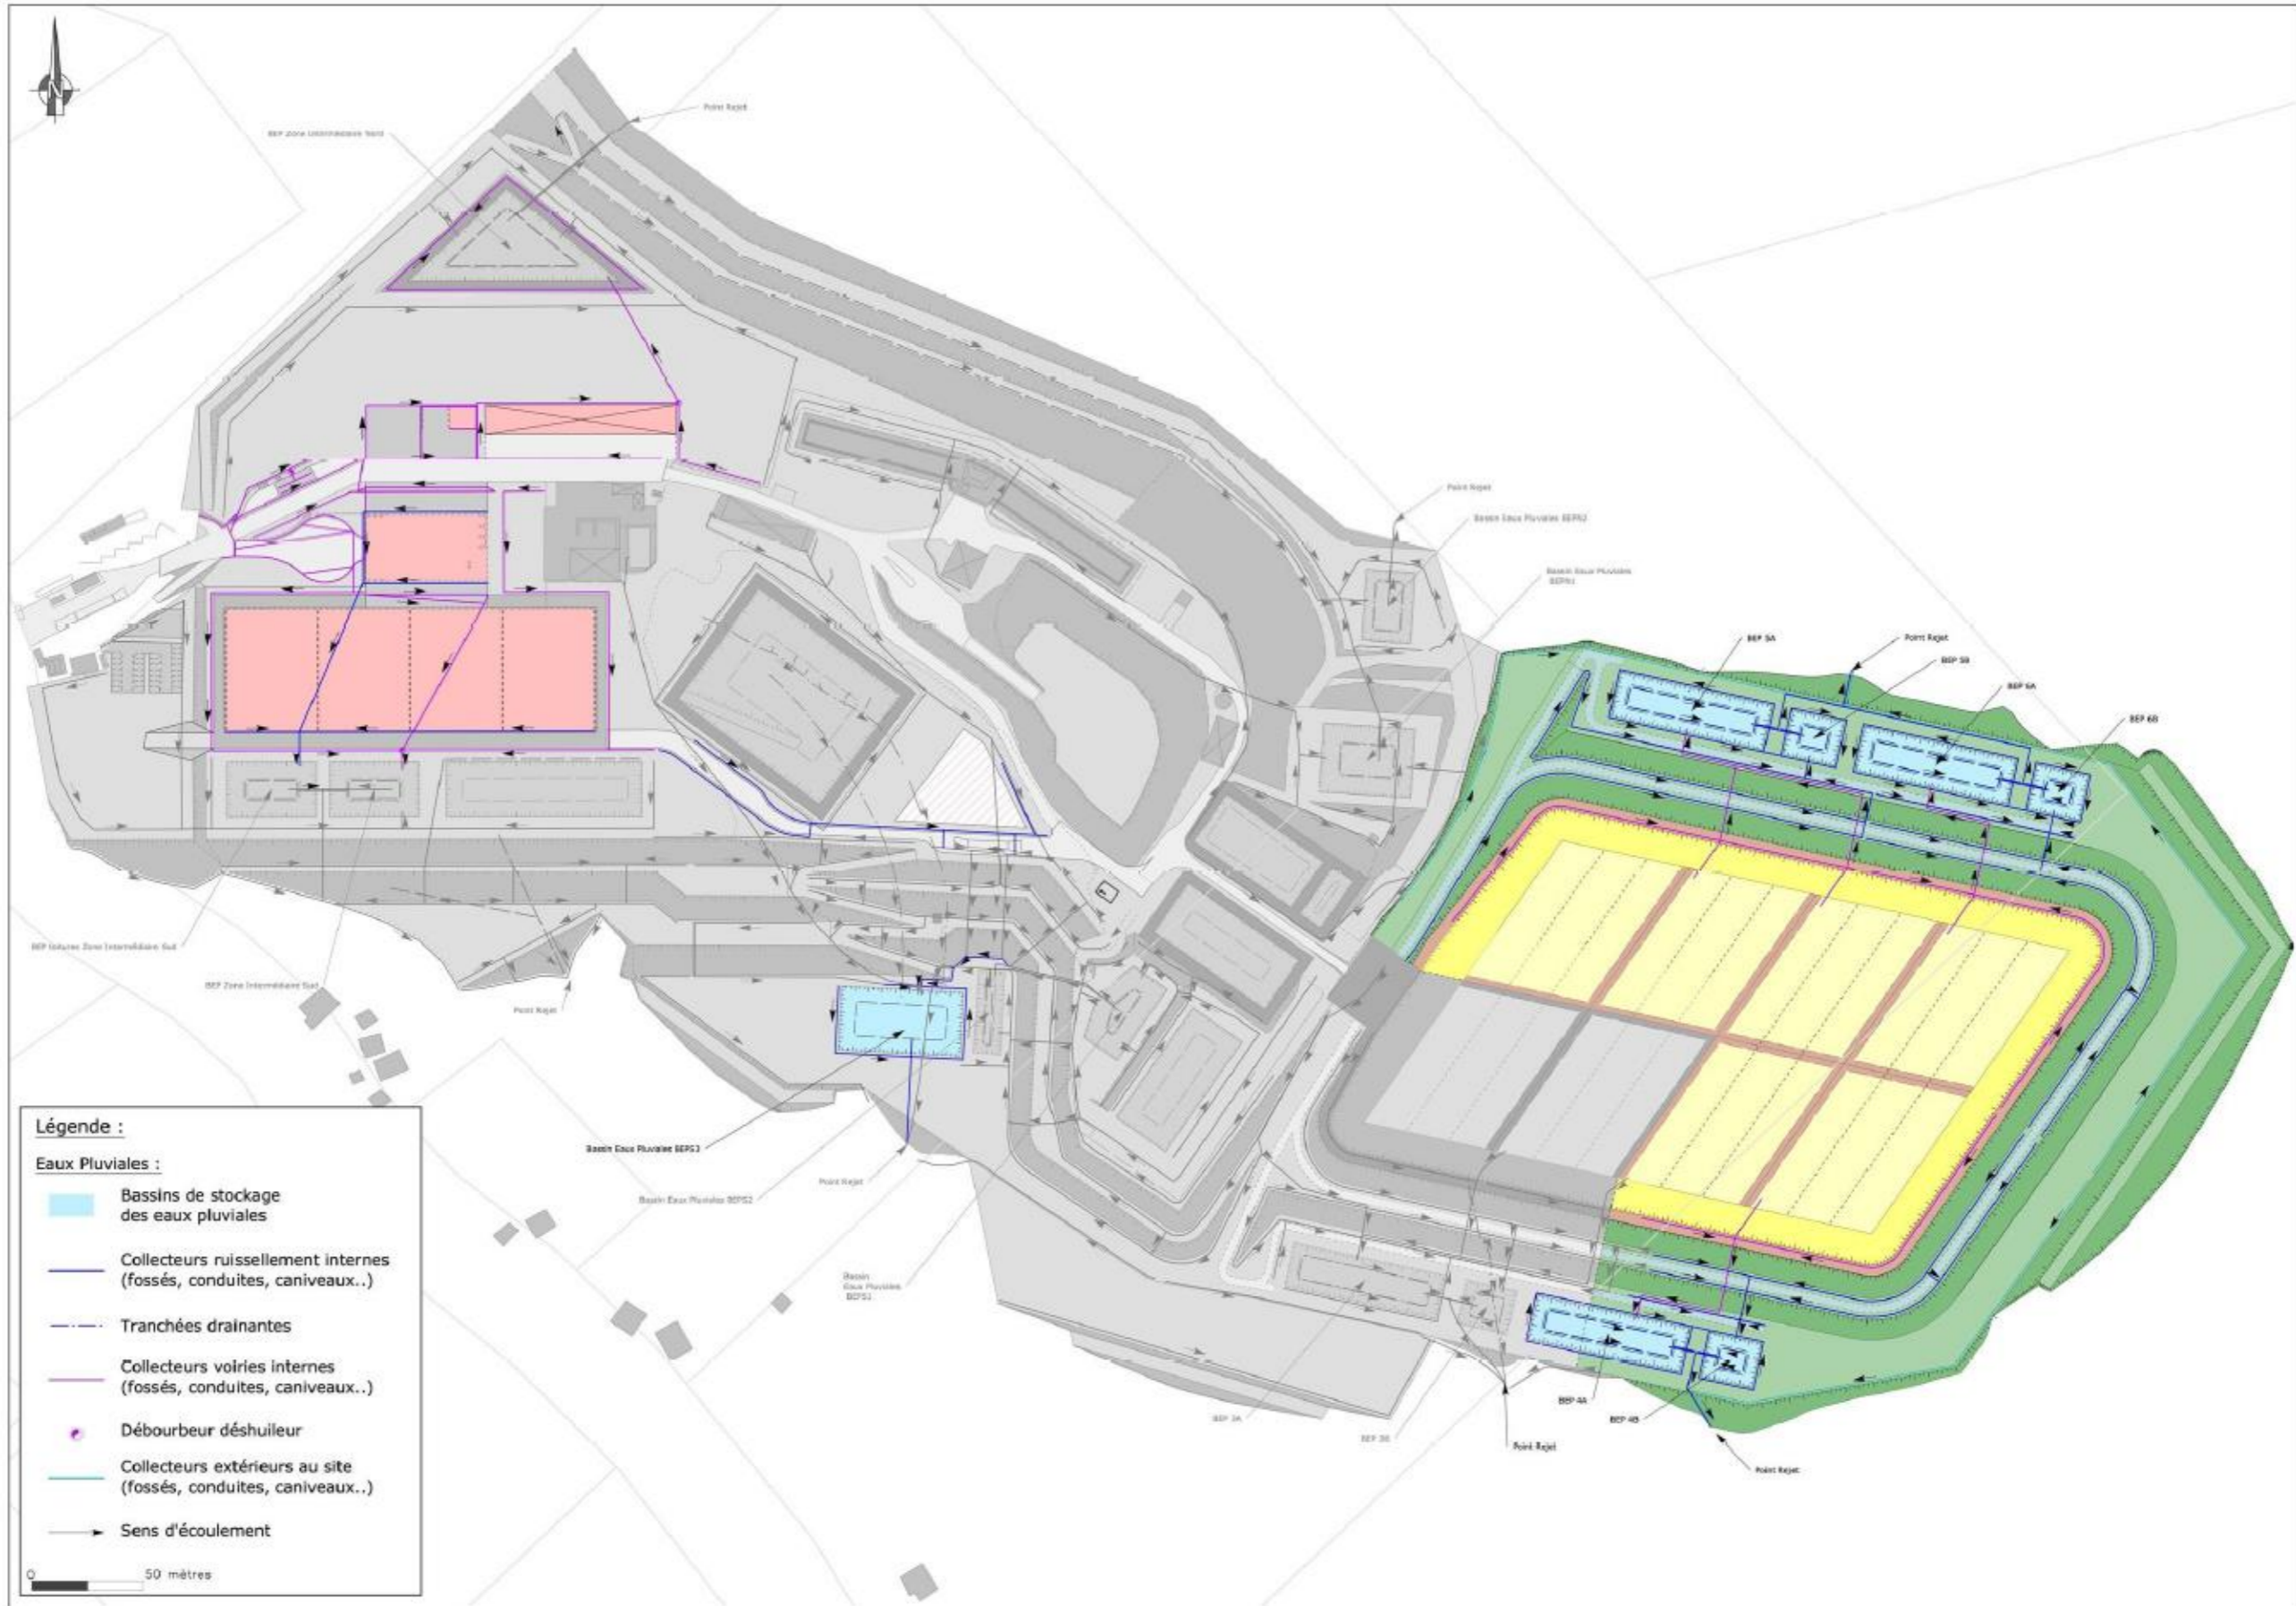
Plan de la gestion des eaux niveau 1 (Source : BETA Environnement)
